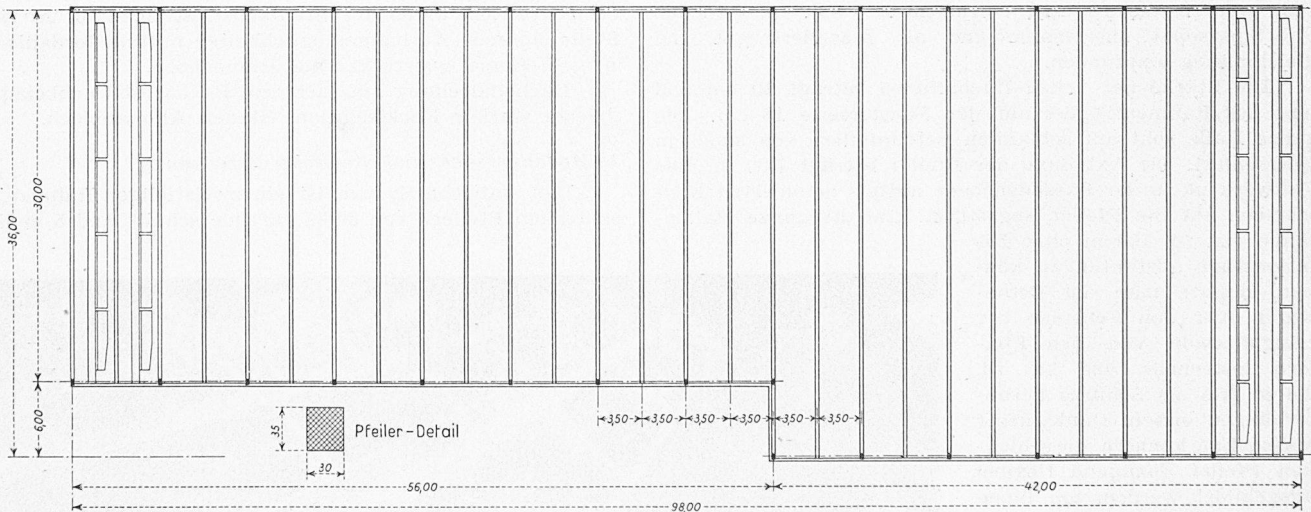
Untersicht des Shedfaltwerks, Masstab 1:600
